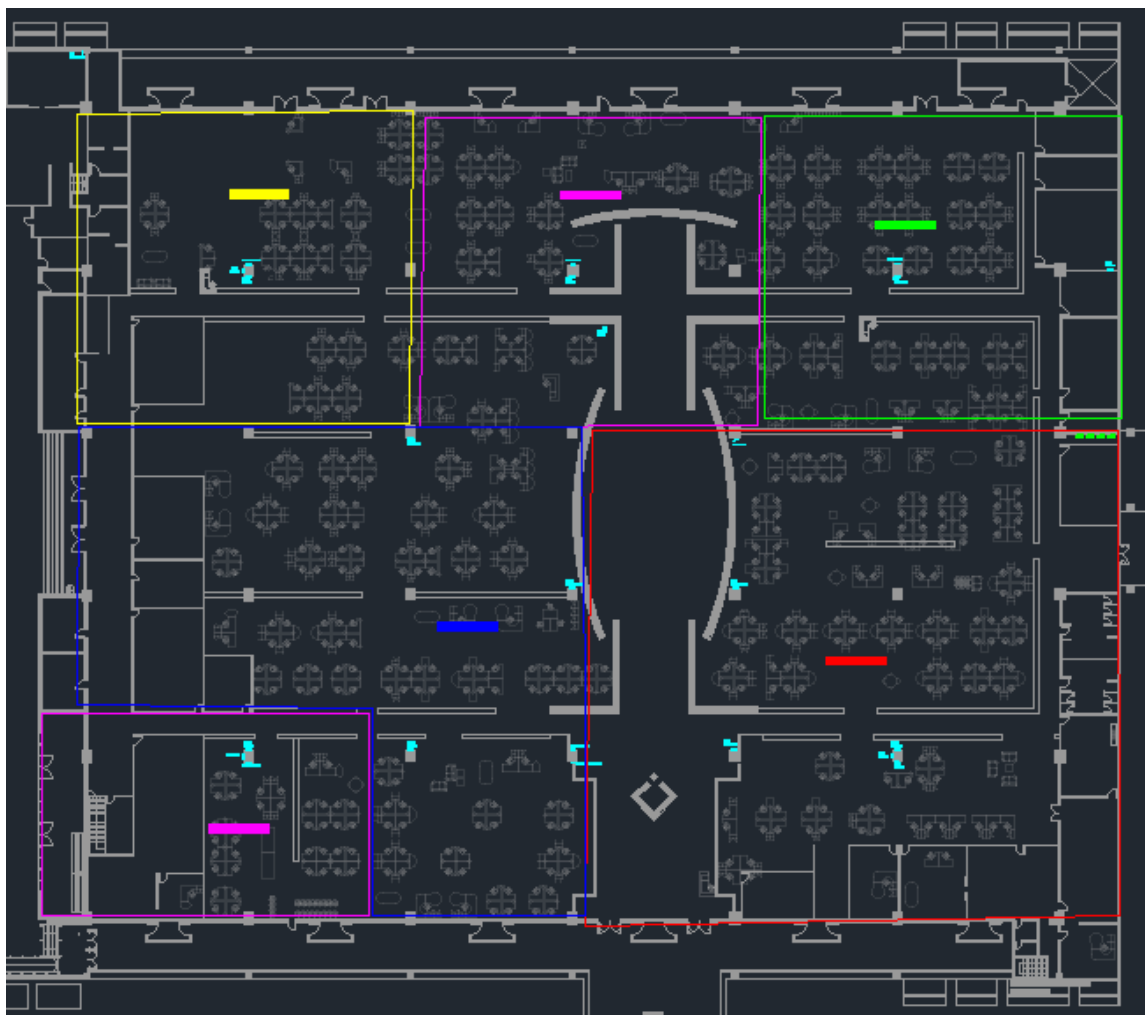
Planta Baixa da SEDUC (posição dos CD's em azul claro)
